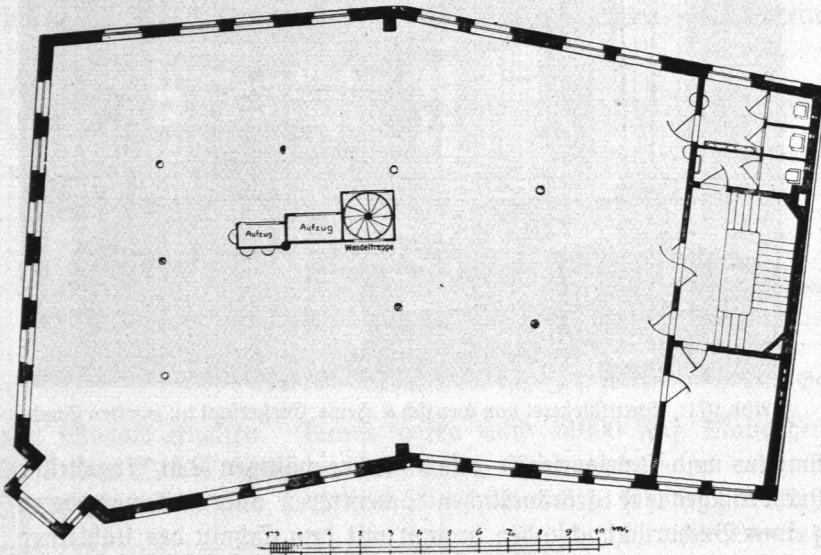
H. D. Perfiel, Gutenberg-Haus, Grundriß des Obergeschosses.
